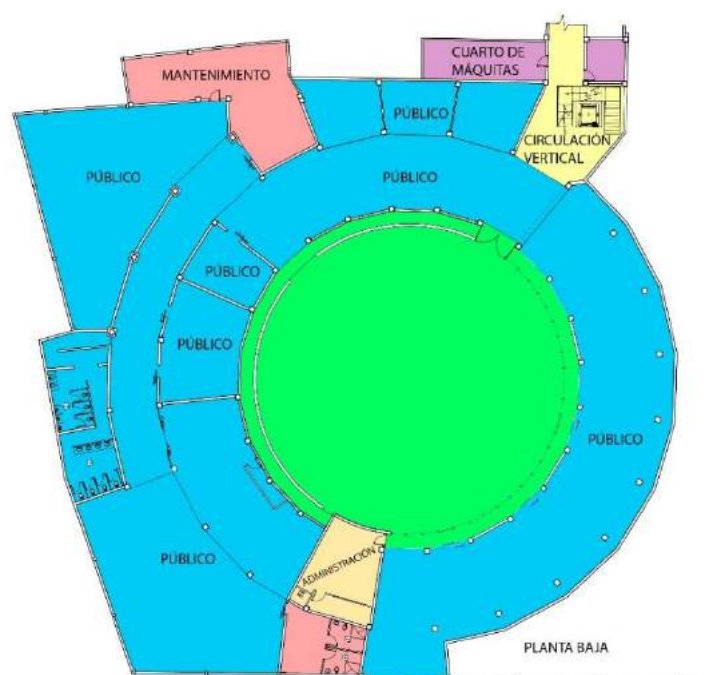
Plan masa planta baja, plaza de toros Belmonte
